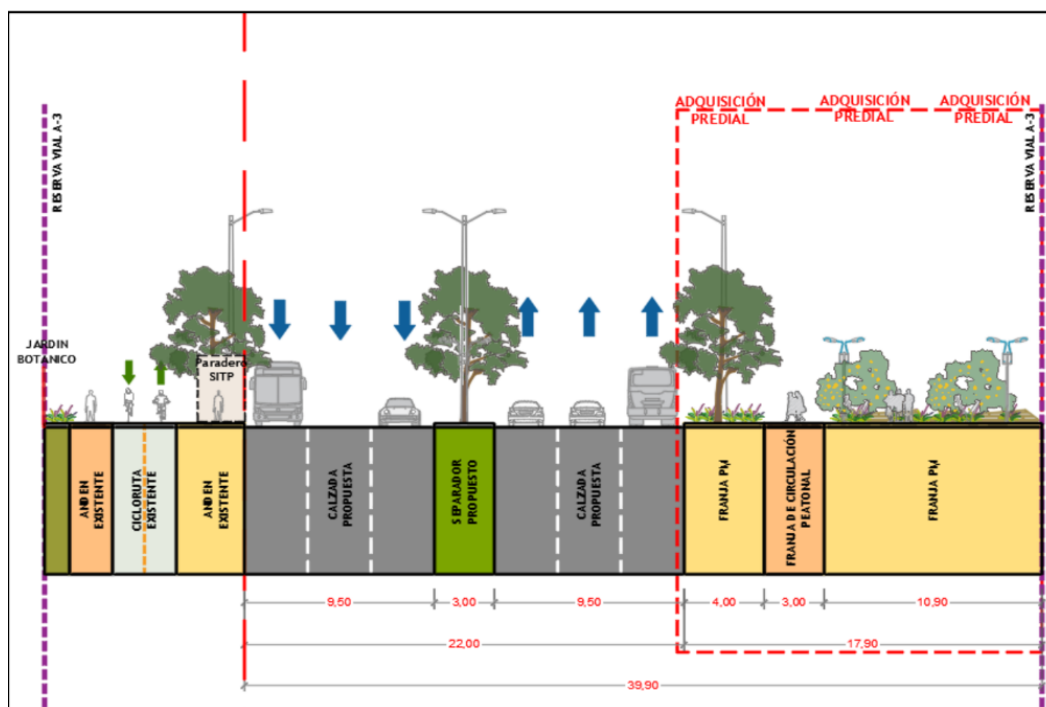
Perfil vial propuesto Av. Calle 63 entre la Carrera 68 y Carrera 70
